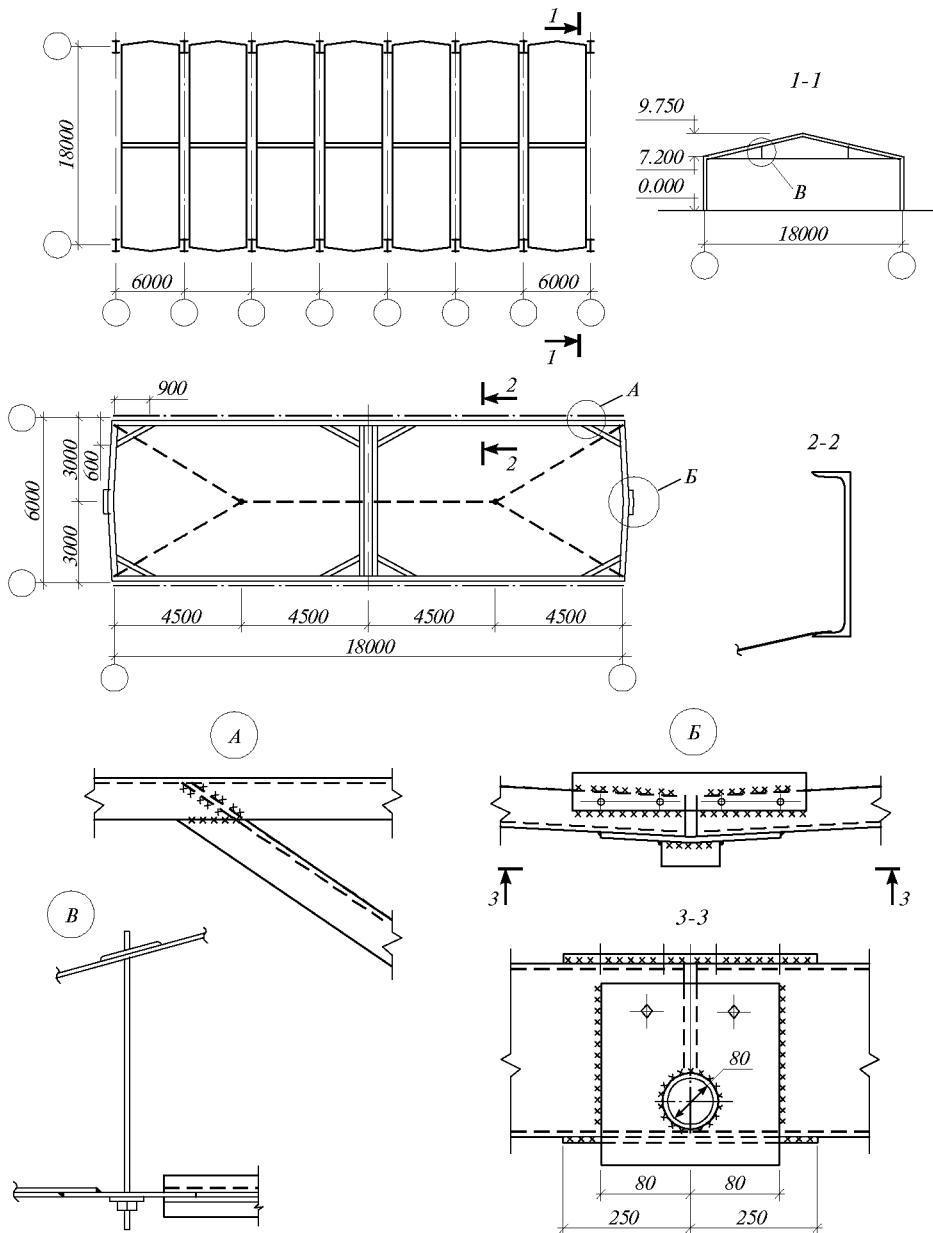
Опытное здание склада пролетом 18 м с покрытием из мембранных панелей
